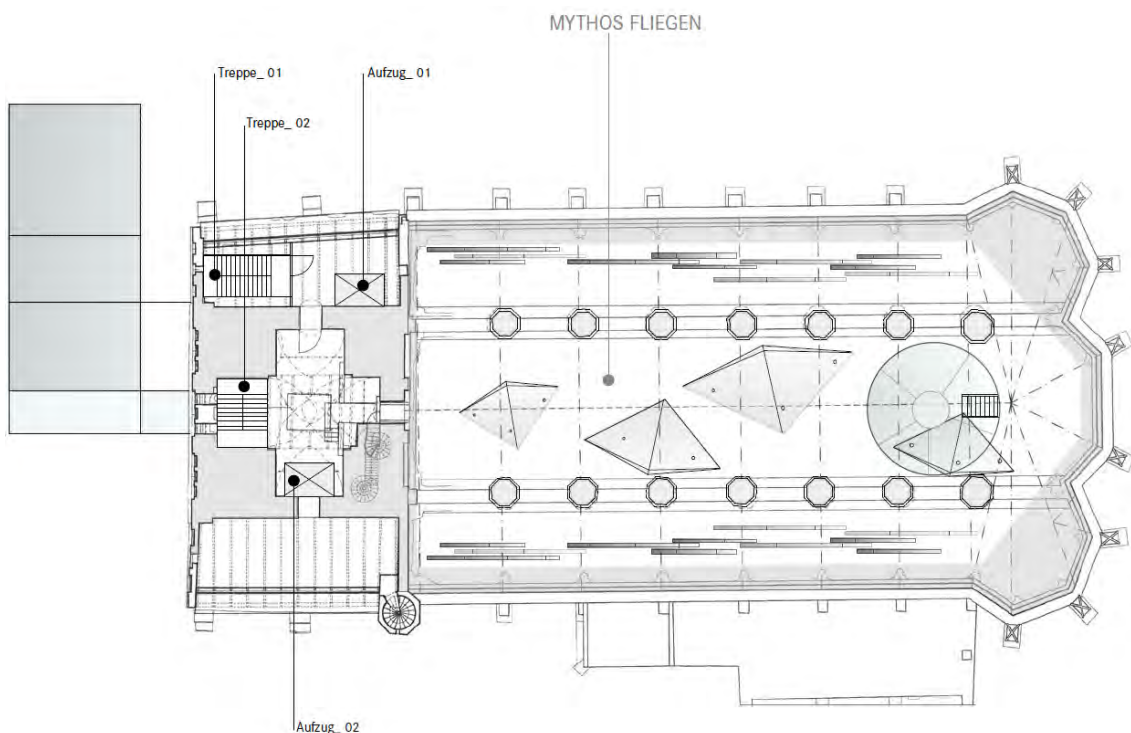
Grundriss der Ausstellungsbereiche im Kronengeschoss
